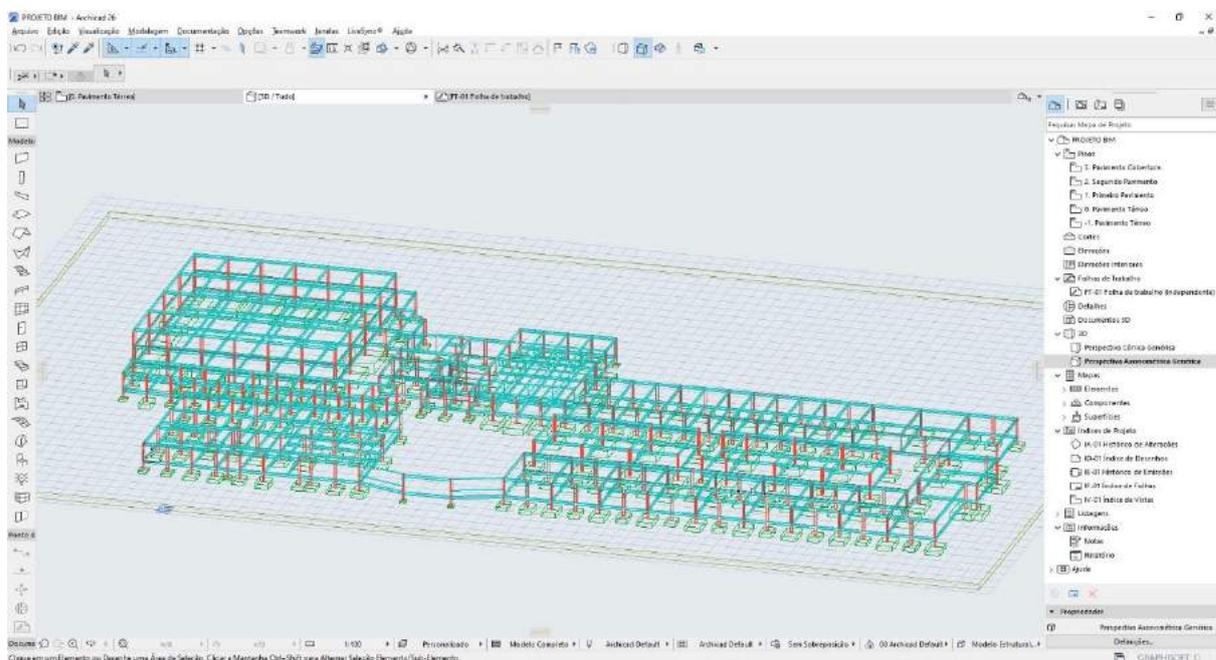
Projeto estrutural em ArchiCAD para o projeto 2 (etapa 2).
